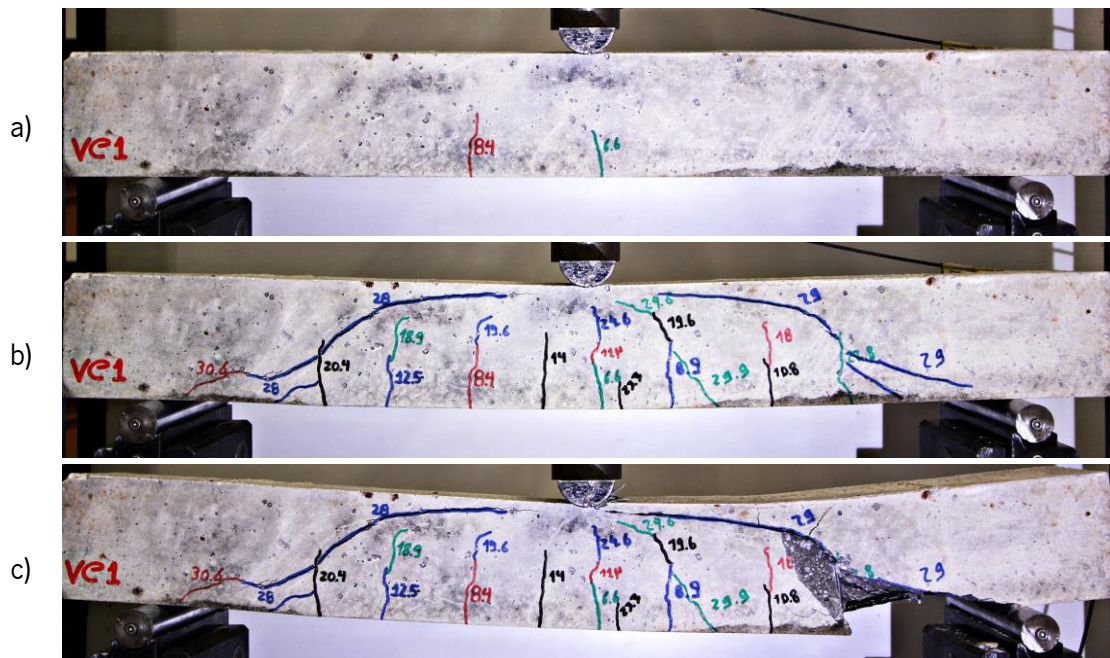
Padrão fissuração laboratorial tipo em vigas de armadura BCR2 (a - primeira fissura; b - pré-esmagamento do betão; c - esmagamento do betão).
